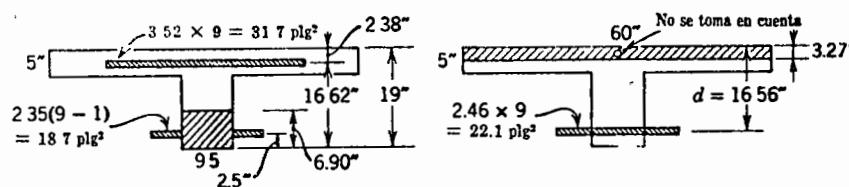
Secciones transversales de la viga consideradas para el cálculo de la flecha
